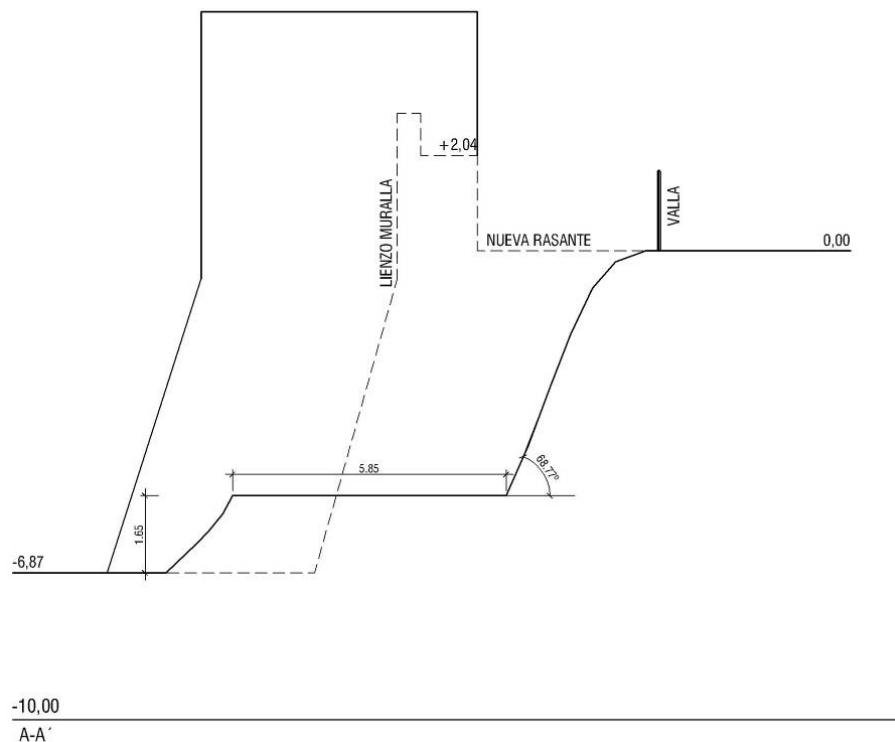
Sección transversal del talud entre las torres Norte y Noroeste. Estado modificado.
